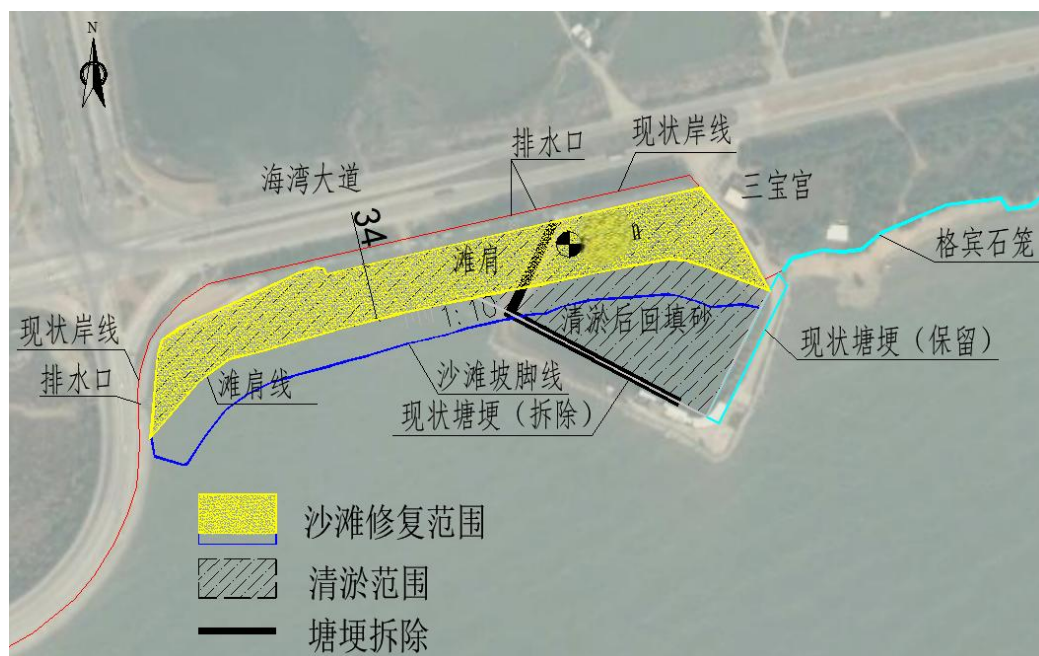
三宝宫外侧沙滩修复平面布置图
